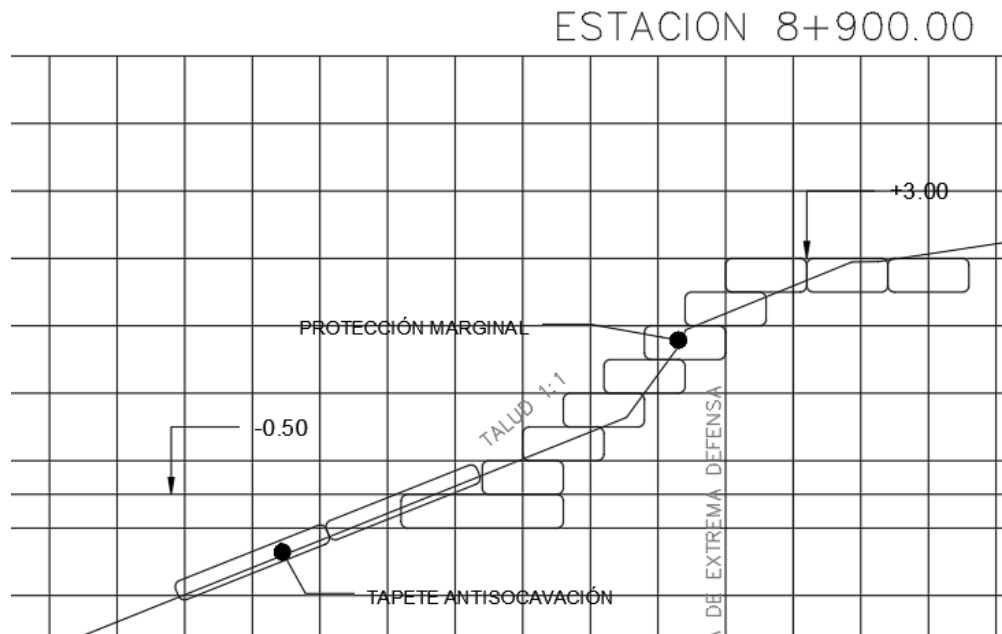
Sección transversal de la protección marginal en el cadenamiento 8+900.
